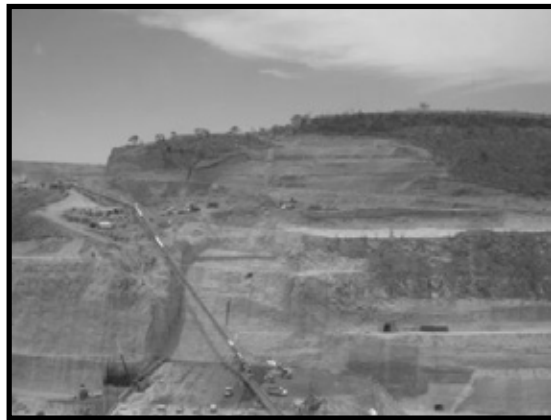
Cobertura con concreto de ladera margen izquierda.
